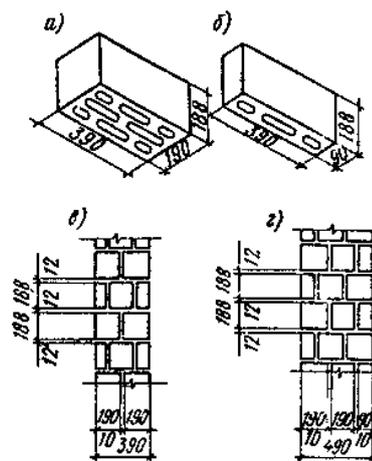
Стена из легкобетонных камней с щелевидными пустотами: А – камень щелевидный; б – продольная половинка; в и г – разрезы стен
